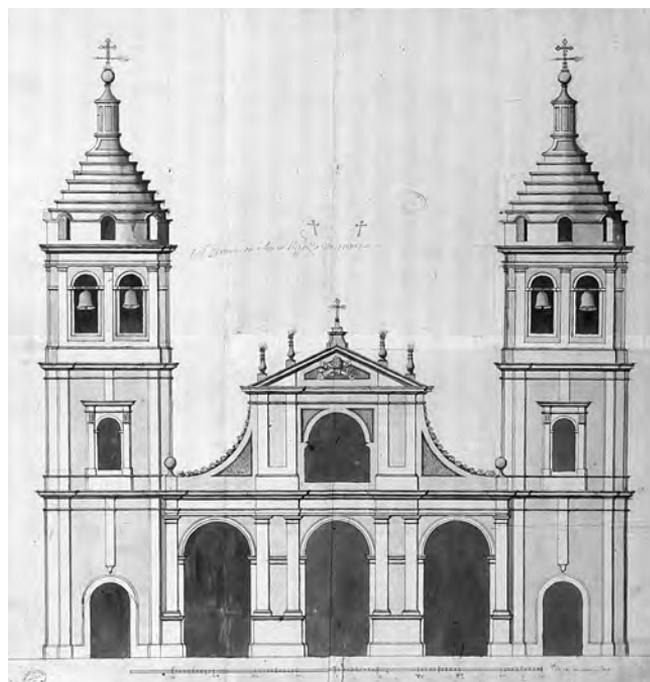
Fachada de la Catedral de Buenos Aires trazada por el hermano Bianchi.
